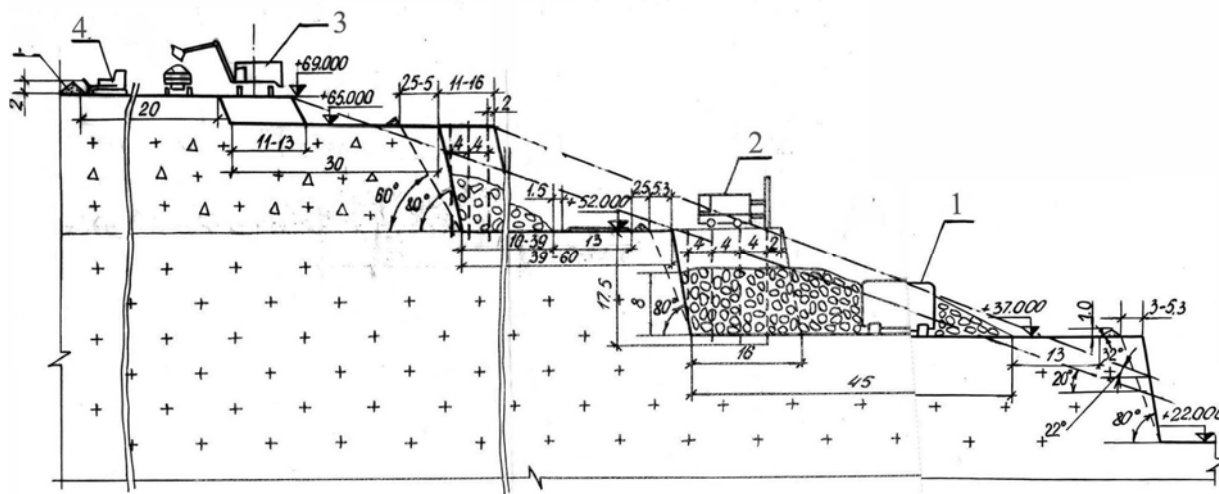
Конструкция рабочего борта карьера (обозначения см. рис.1)
